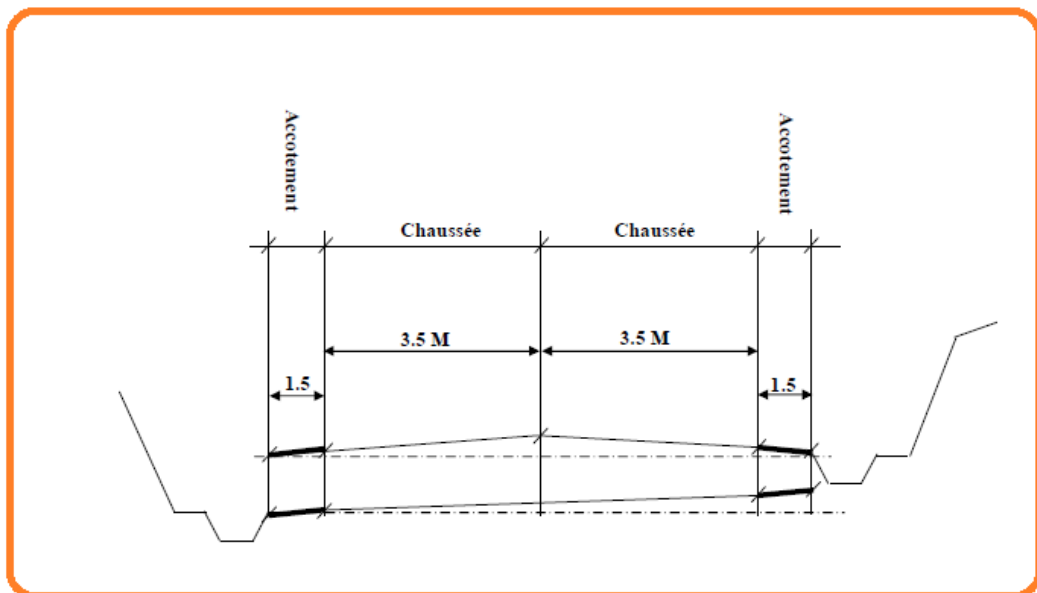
Schéma explicatif d'une coupe transversale de la chaussée prévue.
